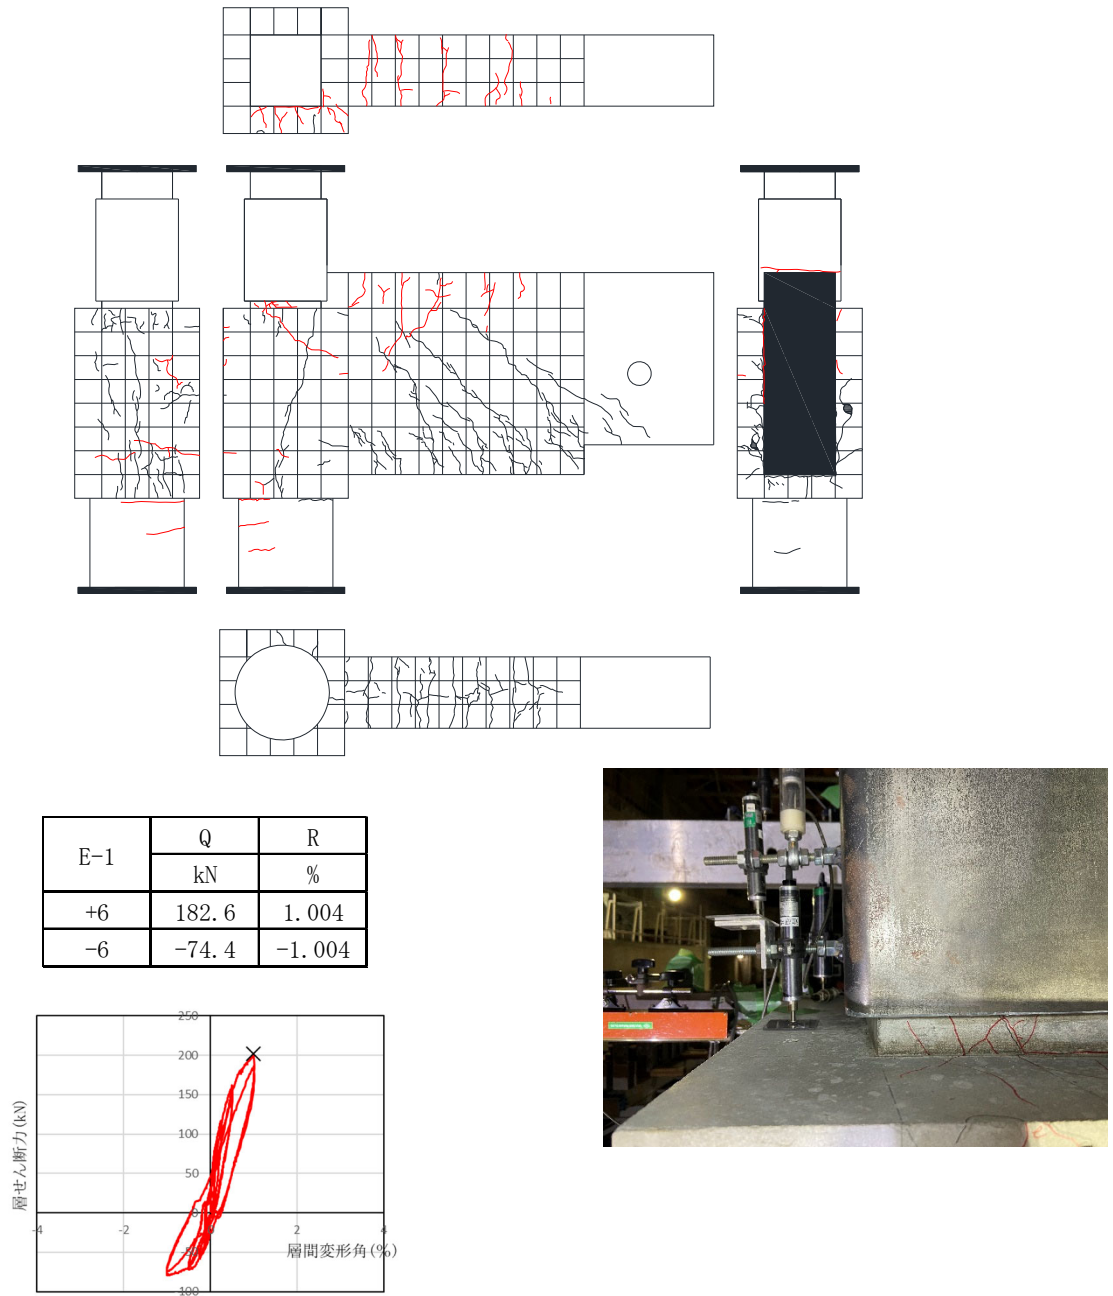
E-1 ひび割れ状況 (3Cycle)
